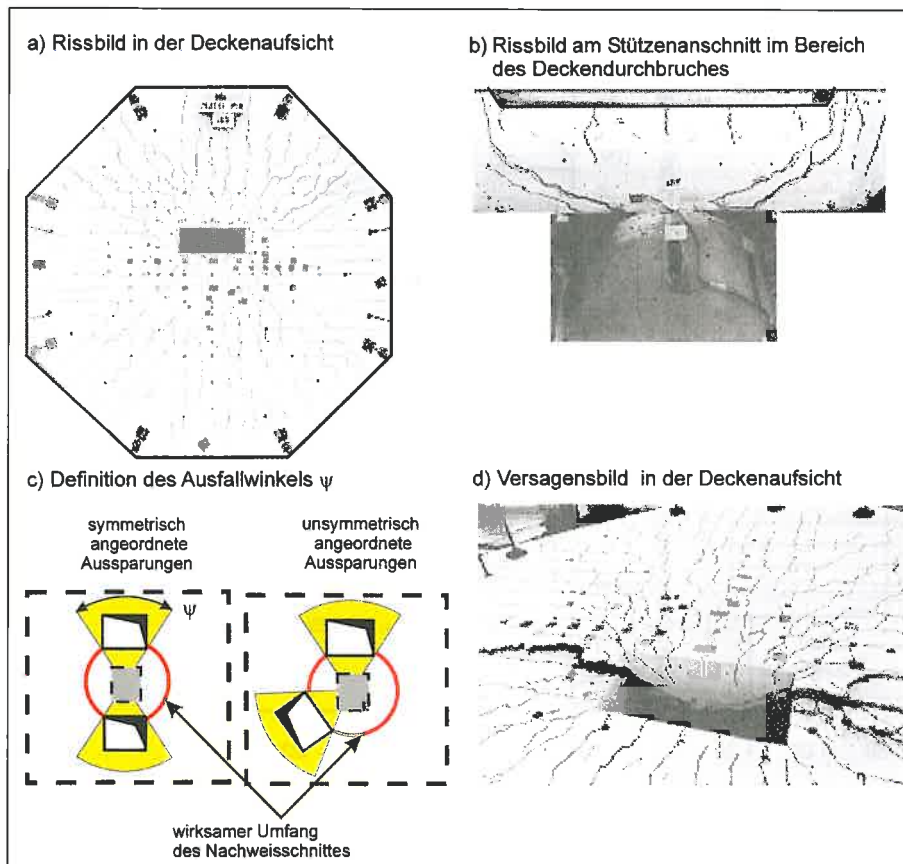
Bruch des Versuchskörpers P 18 aus [11] mit Aussparung im stützennahen Bereich und Definition des Ausfallwinkels  $\psi$
